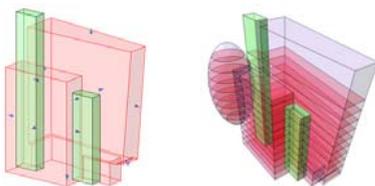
Revit „Building Maker“. Die Grundkörper definieren die gesamte Gebäudehülle. Das gesamte Modell ist eine Datei, die Geschosse schneiden das Modell als entsprechenden Grundriss-View. Aus den Geschosshöhen und den Gebäudeelementen (GE) können die einzelnen Bauteil-Objekte (Decken, Fassaden, Dächer ...) durch „Anklicken“ abgeleitet werden. Änderungen an den GEs werden von den Bauteil-Objekten nachgeführt. [Revit, Autodesk]
